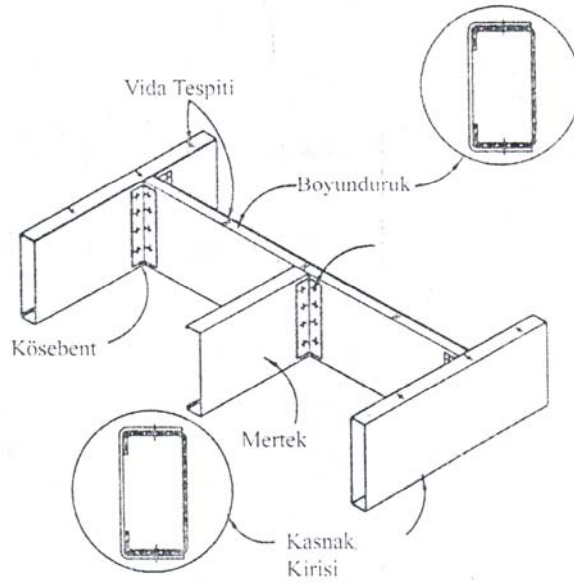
Tavan kirişinde ek yapılması (NASFA, 2000)
